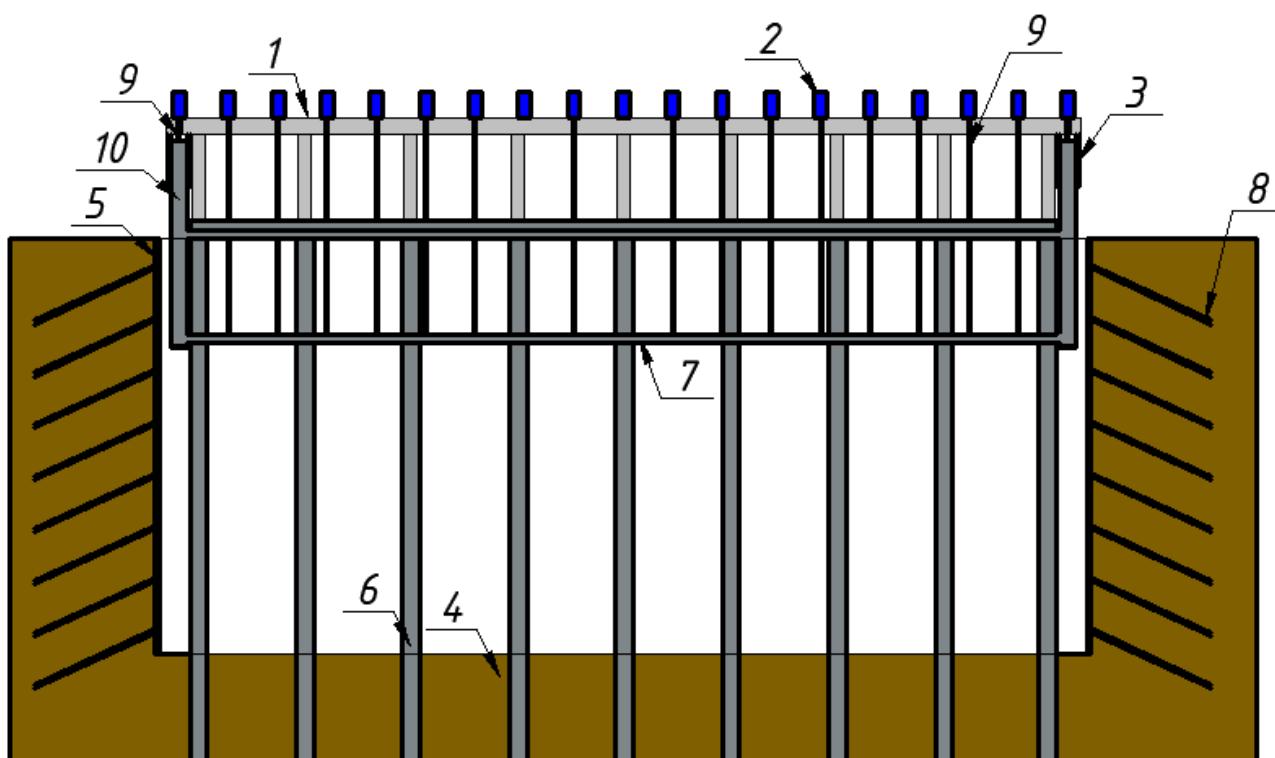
Устройство следующей плиты перекрытия и дальнейшая разработка котлована
